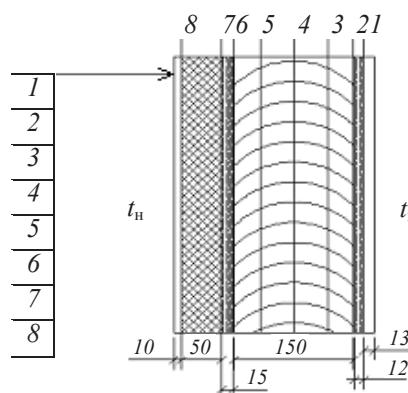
Конструкция стены дома каркасного типа с дополнительным утеплителем:
